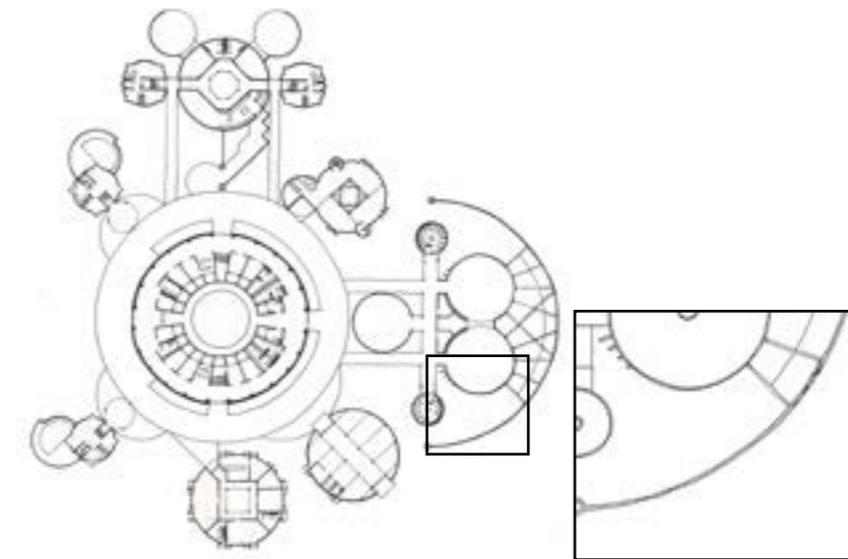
Planta de implantação do projeto “Zip Zap Circus School” de Pancho Guedes, 1984-1985, com pormenor selecionado por Ângela Ferreira para a realização da escultura. Arquivo P.G.
